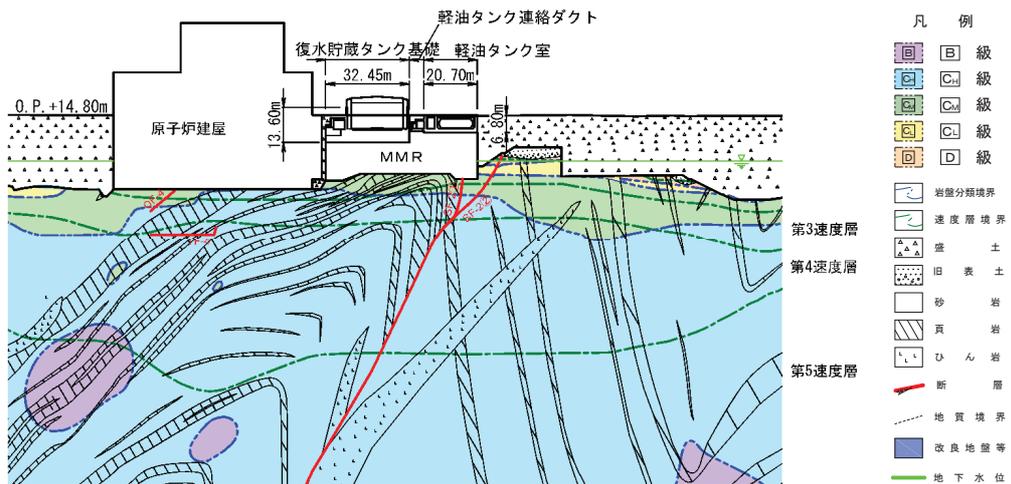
分類 a (MMR) 評価断面図 (軽油タンク室の南北断面)
